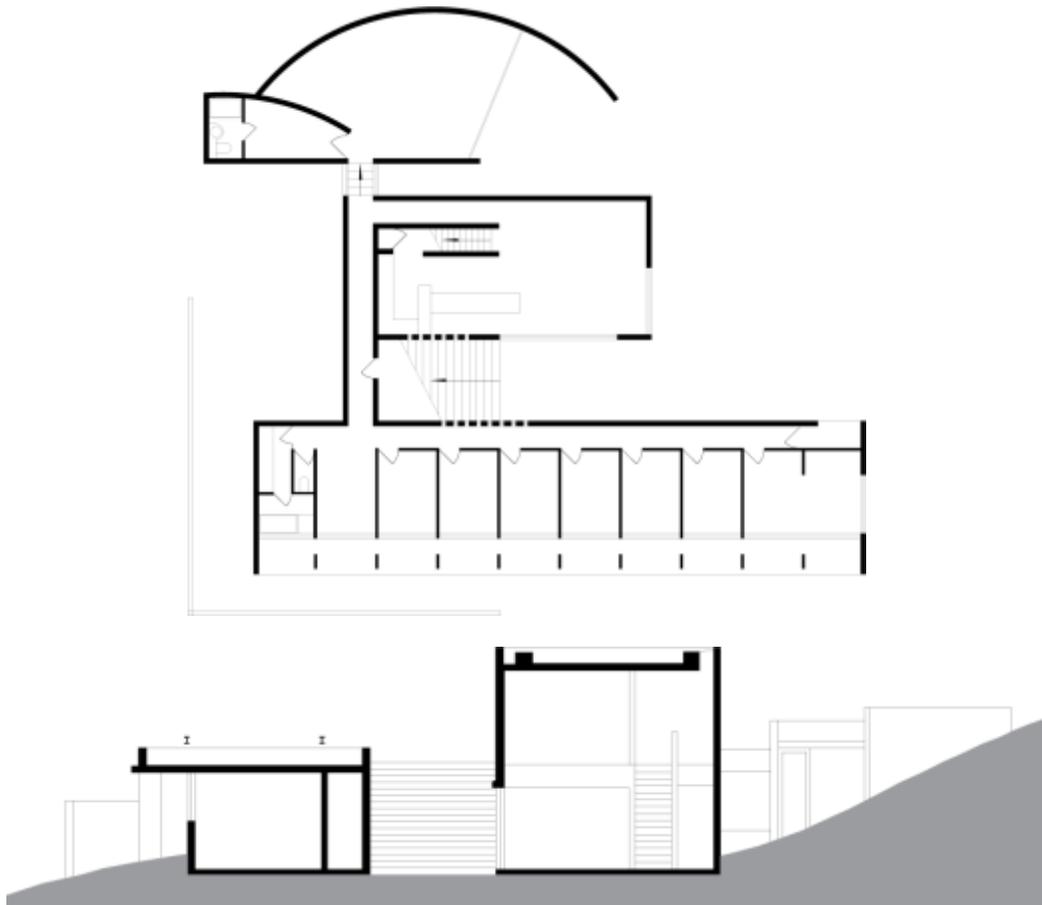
Y FIGURA 44. Planta baja y sección de la casa Koshino.
